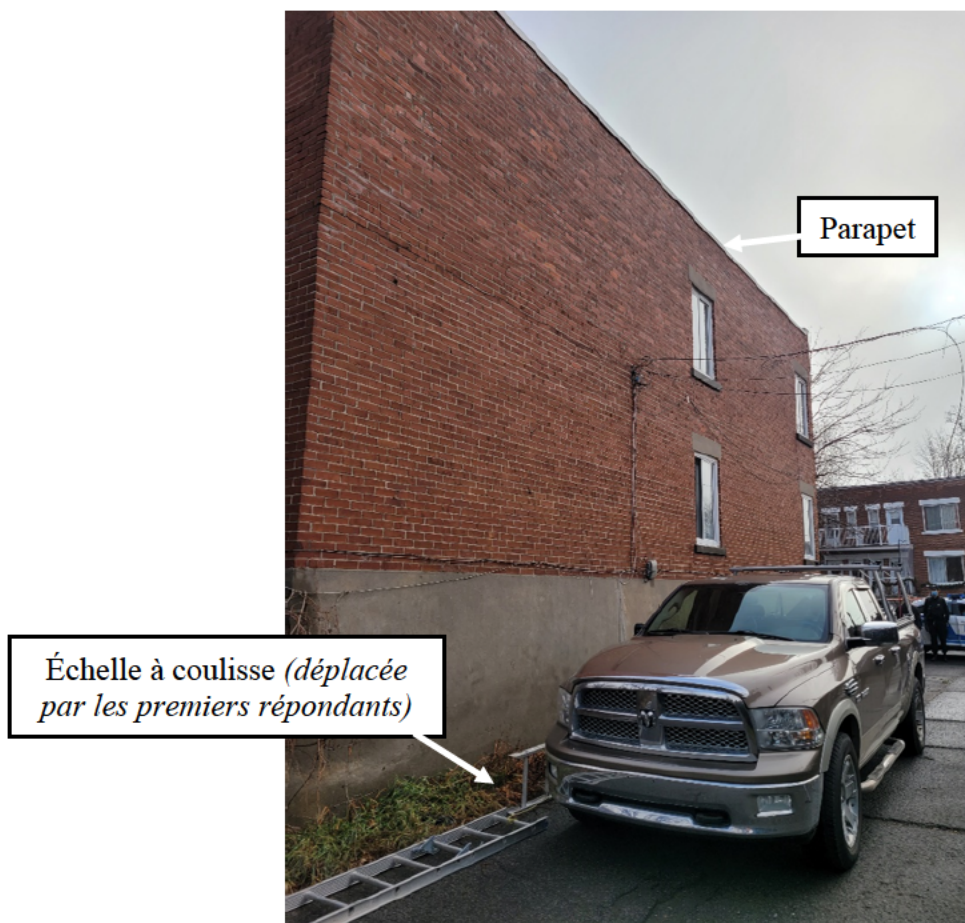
Ruelle et mur ouest du bâtiment (Source : CNESST)
